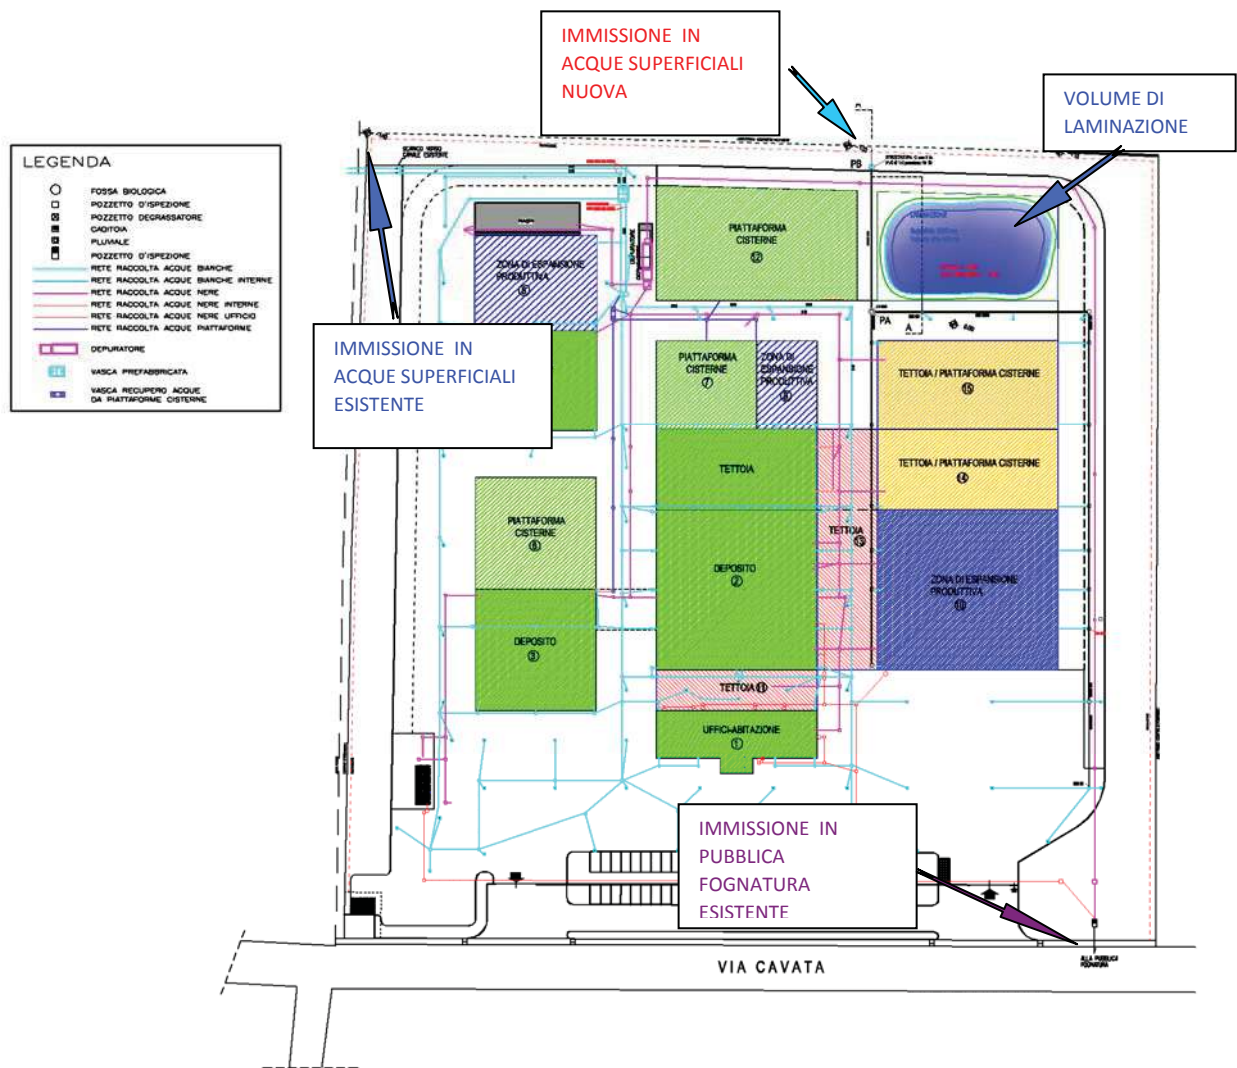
PLANIMETRIA GENERALE RETI FOGNARIE ESISTENTI E DI PROGETTO
